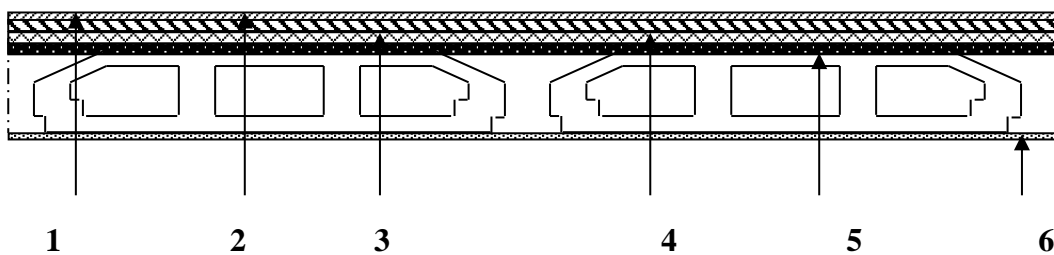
Coupe verticale du plancher terrasse a corps creux .
